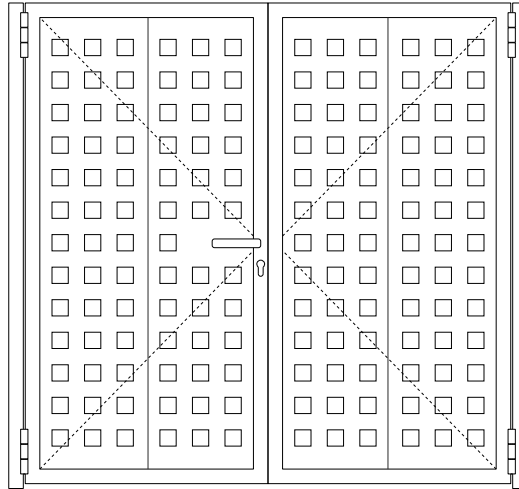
Detalle de alzado de Puerta Batiente Peatonal de 2 hojas.
